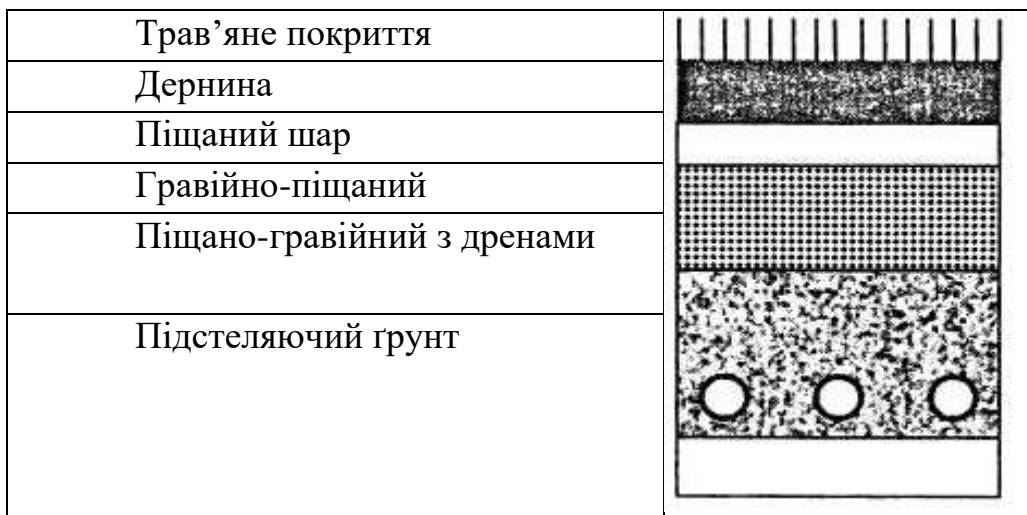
Схема будови профілю ґрунту футбольного поля
